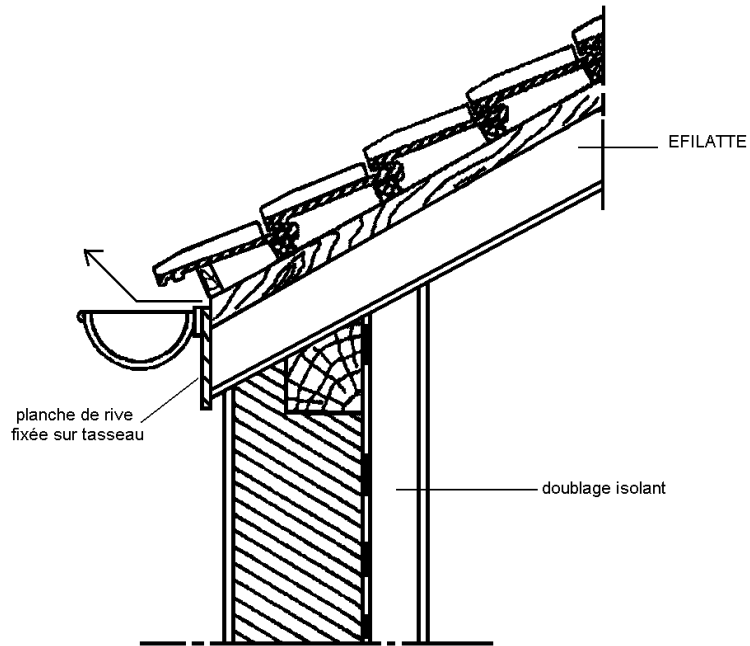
Finition en rive d'égout par caisson arasé en façade et planche de rive
